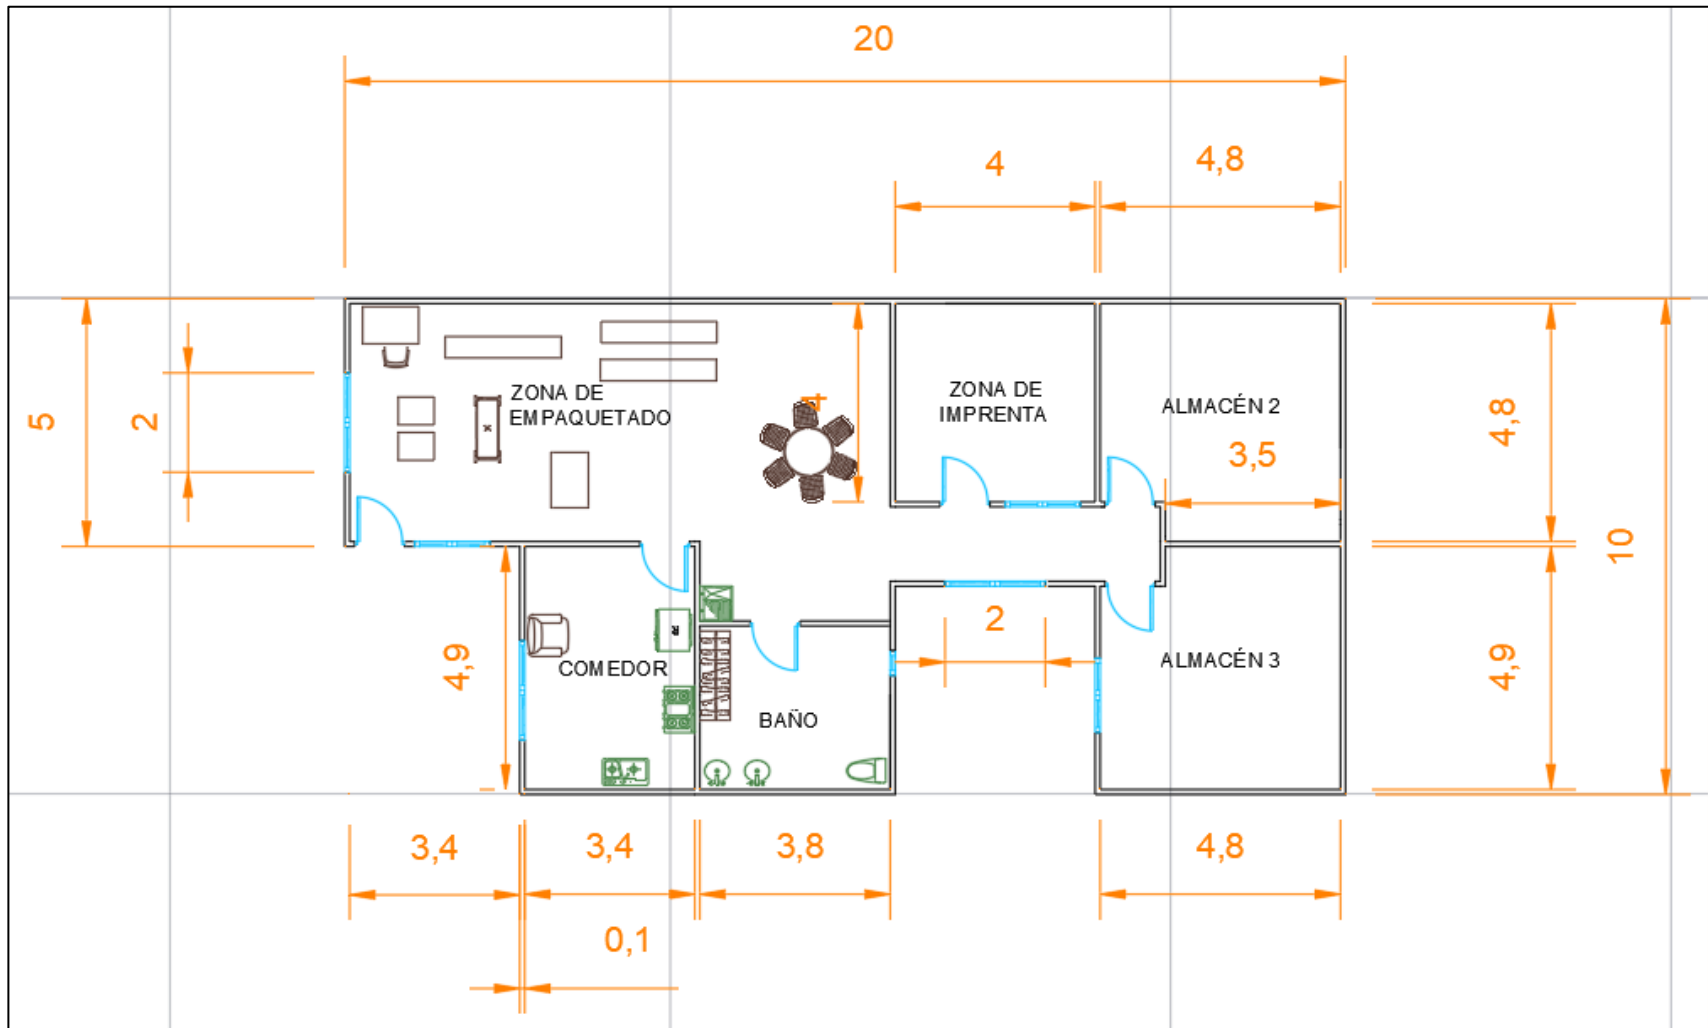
Distribución Actual de la Planta en software AutoCAD
